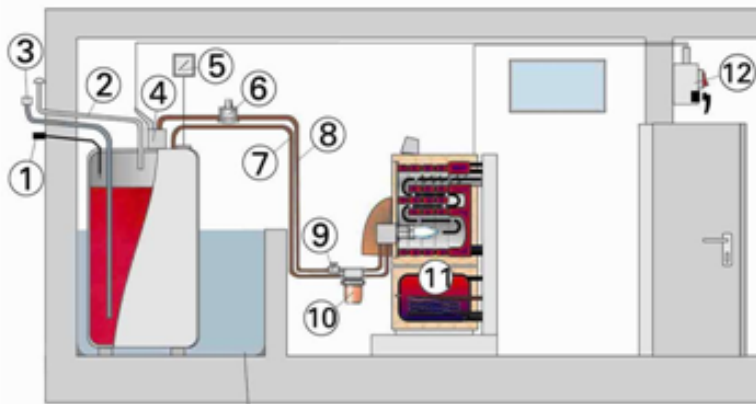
Heizraum mit Wärmeerzeuger und Öltank
